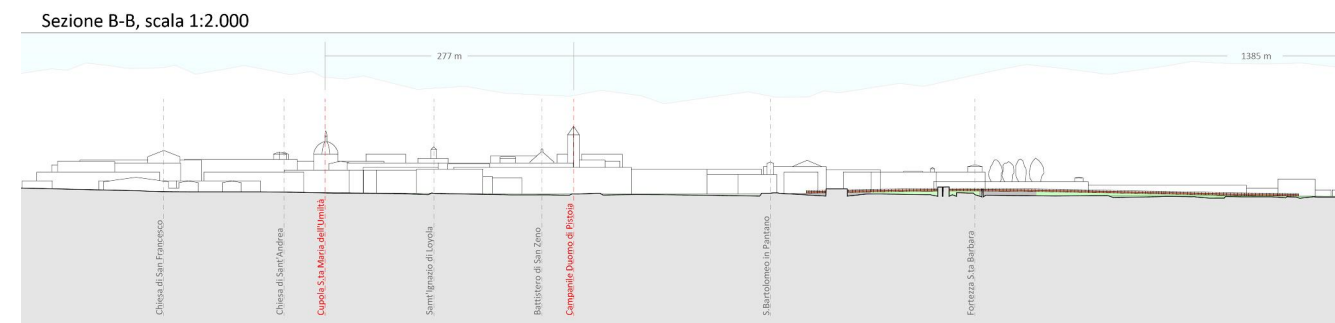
Estratto Sezione B - B (tratto ovest)
